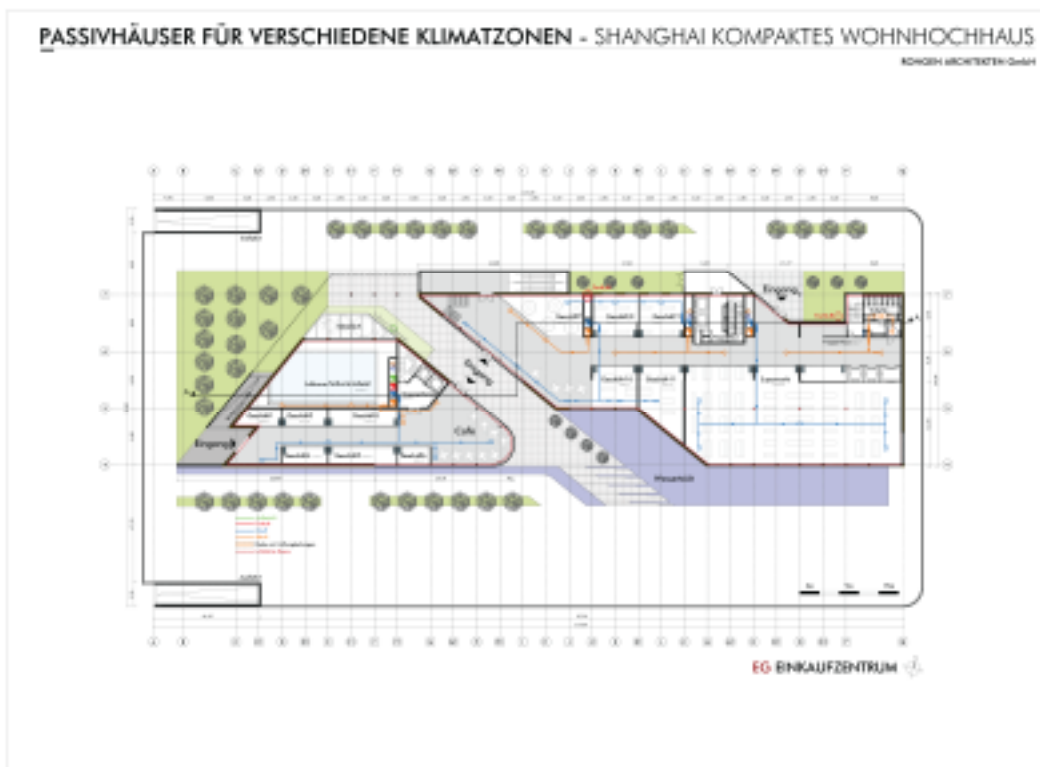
Wohnhochhaus Shanghai – Grundriss Ebene 1 (Straßenniveau)
